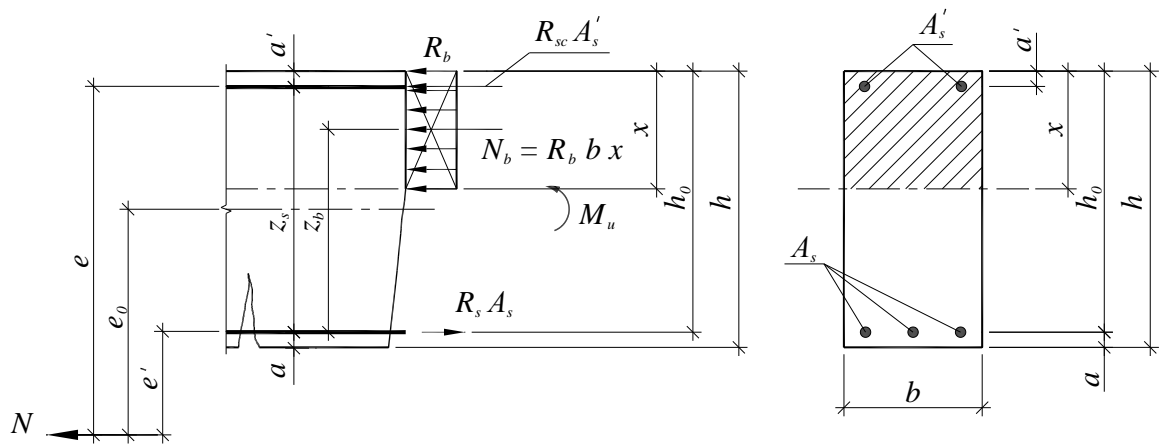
Расчетная схема растянутого элемента при больших эксцентриситетах.
